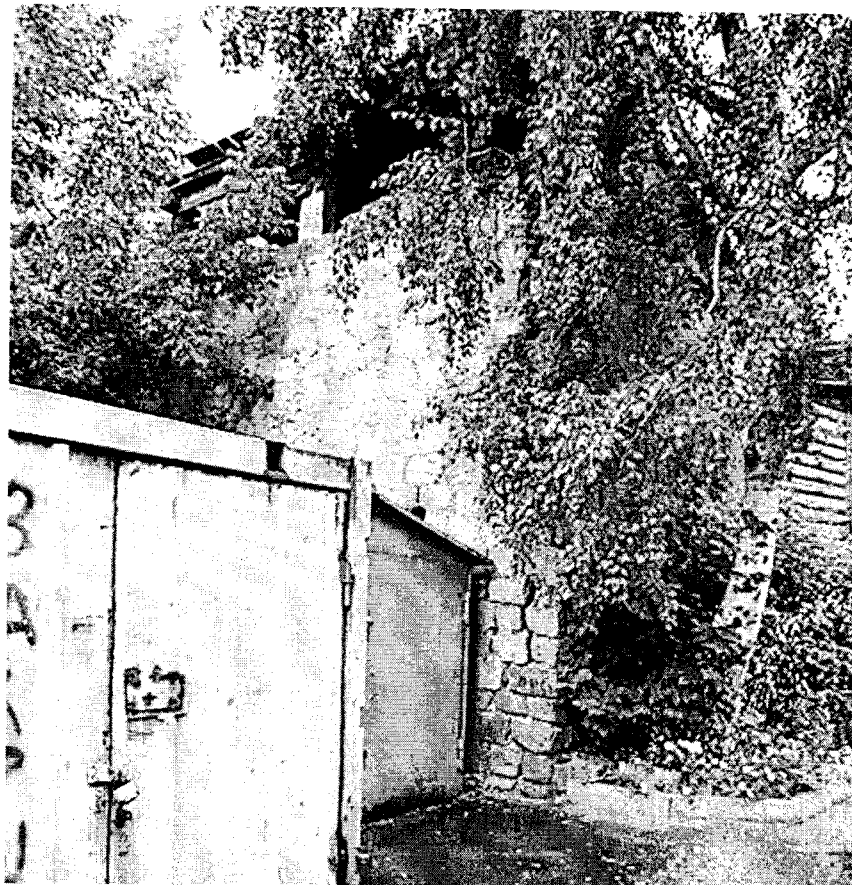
Фрагмент продольного (юго-восточного) фасада амбара (выезда)
